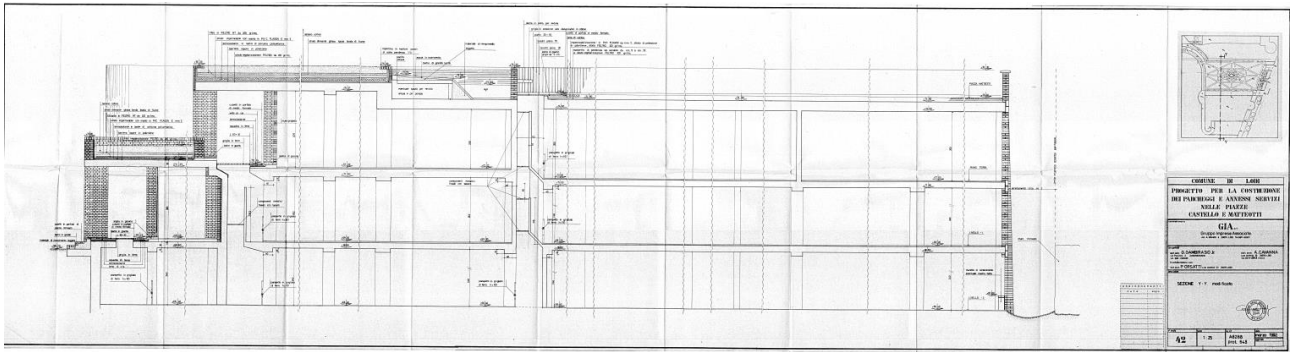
Sezione trasversale parcheggio Piazza Matteotti
